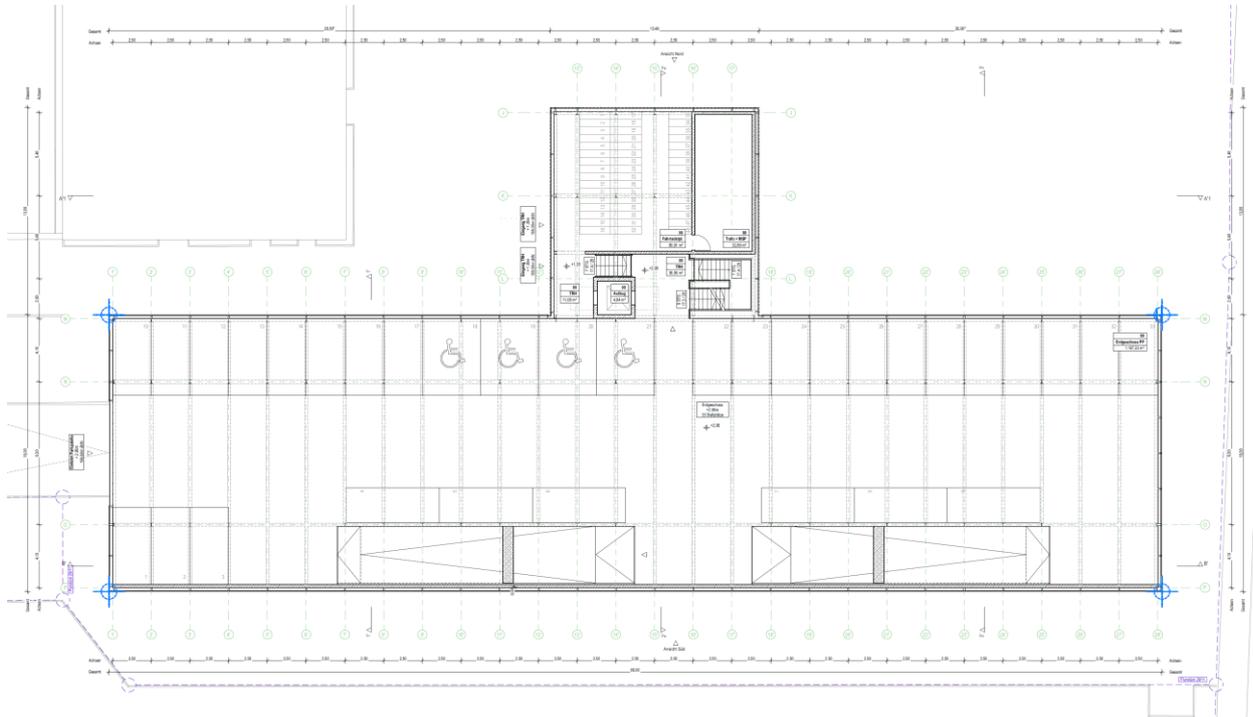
Grundriss Erdgeschoss, unmaßstäblich
